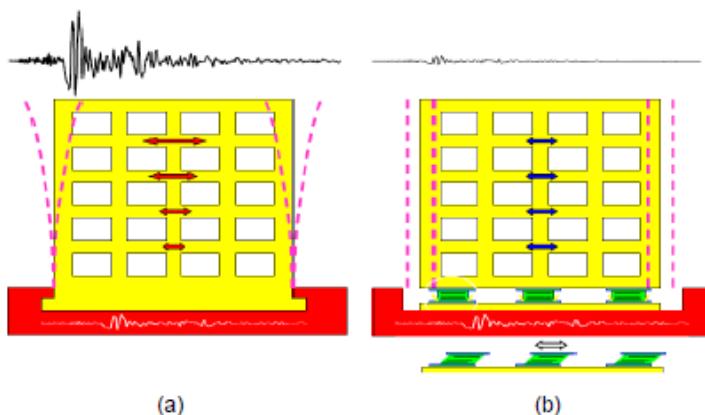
а) - Будівлі без ізоляторів, б) - Будівлі з ізоляторами
